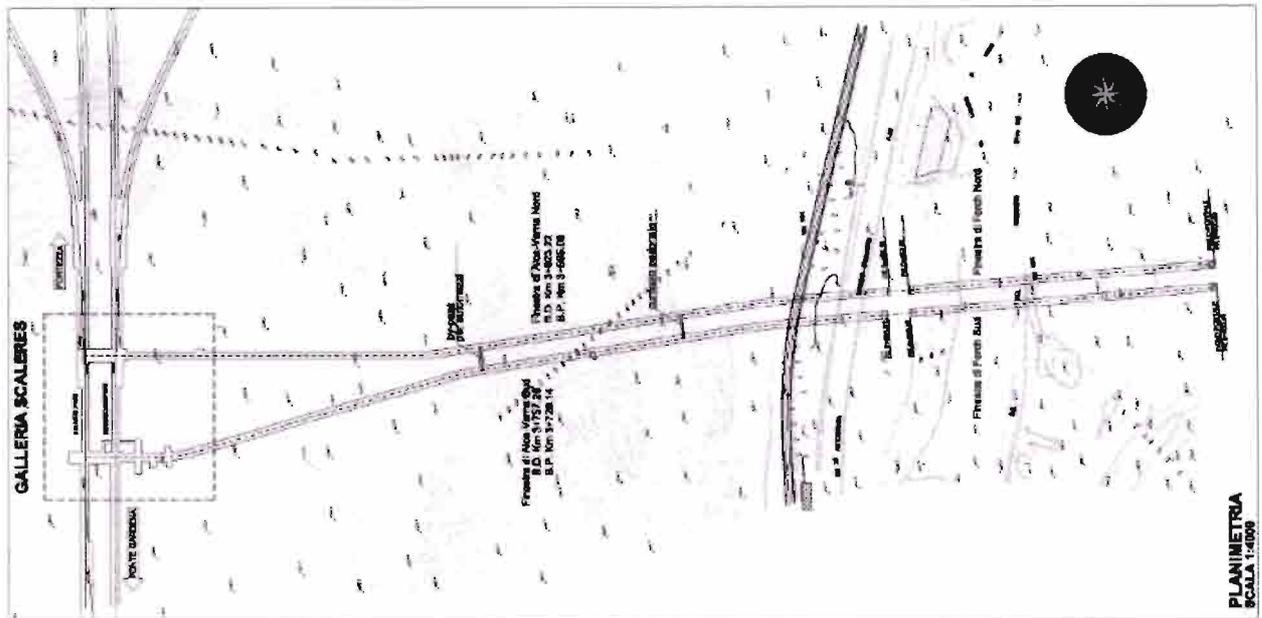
Stralcio planimetrico doppia finestra Aica-Varna
